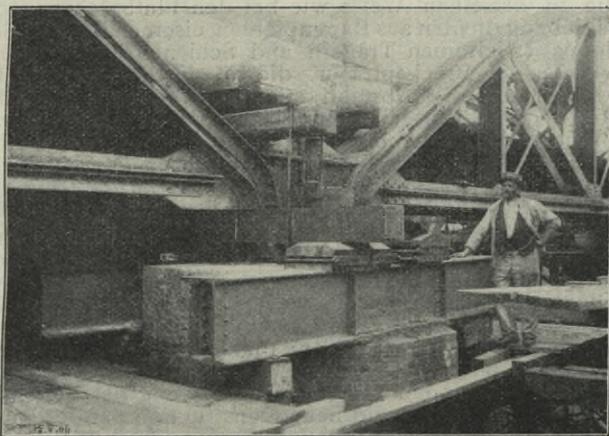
Auswechslung eines beweglichen Auflagers. Elbe-Brücke bei Magdeburg. Aus D. B. Z. 1908, S. 531.
